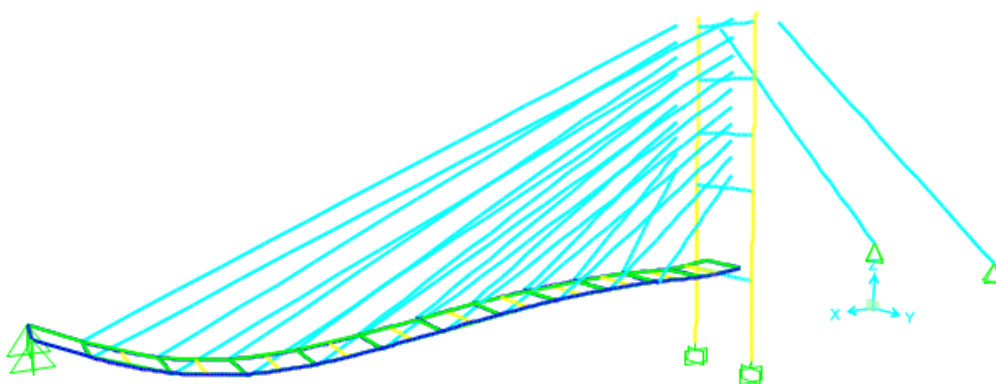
Deformación por carga muerta más viva de la estructura, estado tensado
